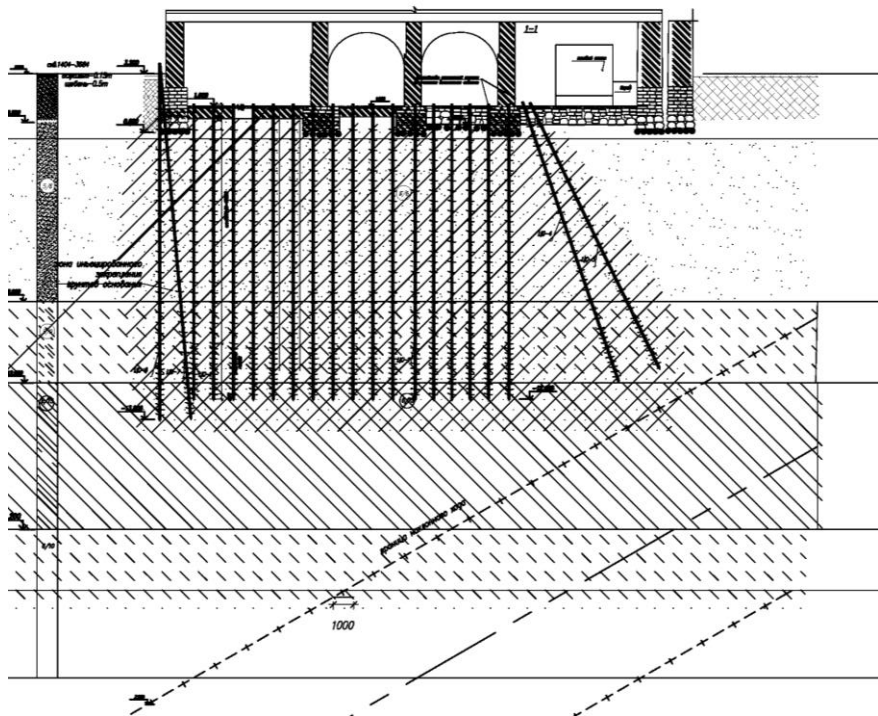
Поперечный разрез по зданию, совмещенный со схемой расположения манжетных колонн под зданием
